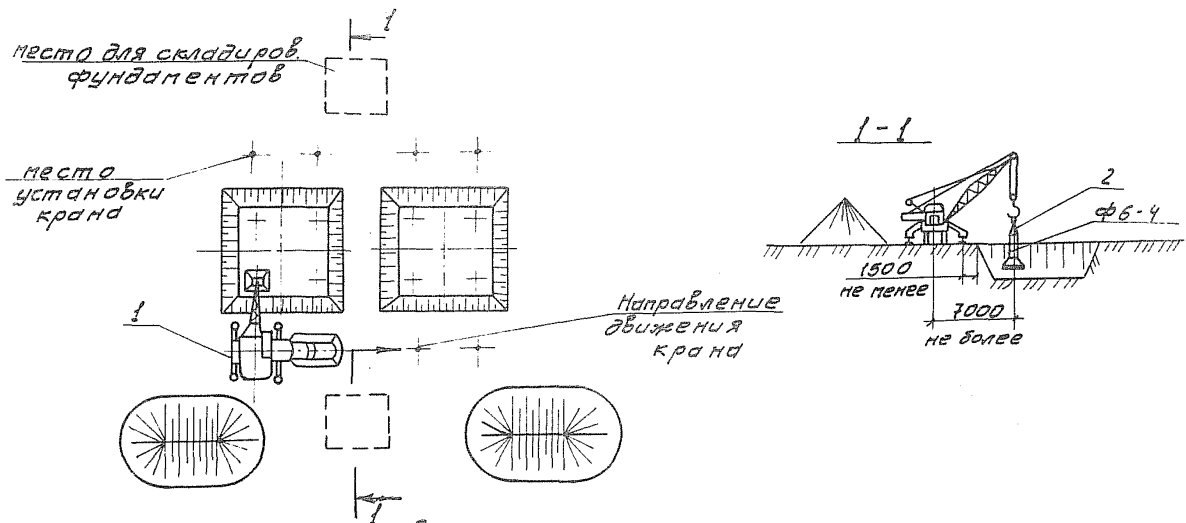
Схема установки ж.б. фундаментов в грунтах II группы
